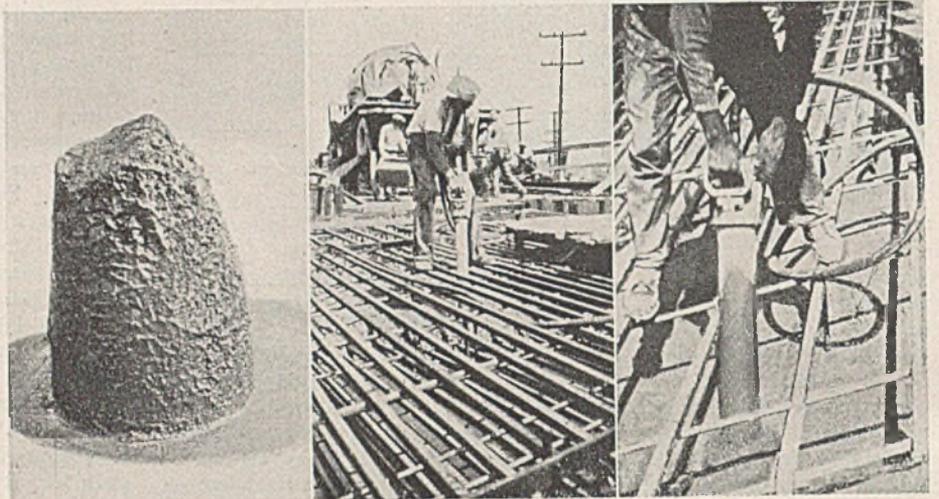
Einrütteln des Betons bei engen Eiseneinlagen.
